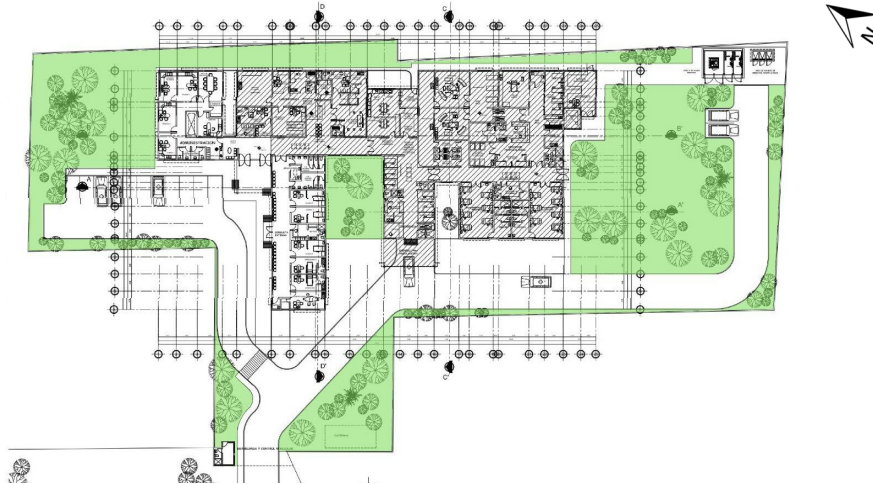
Planta arquitectónica CAIMI, Santiago Atitlán;
